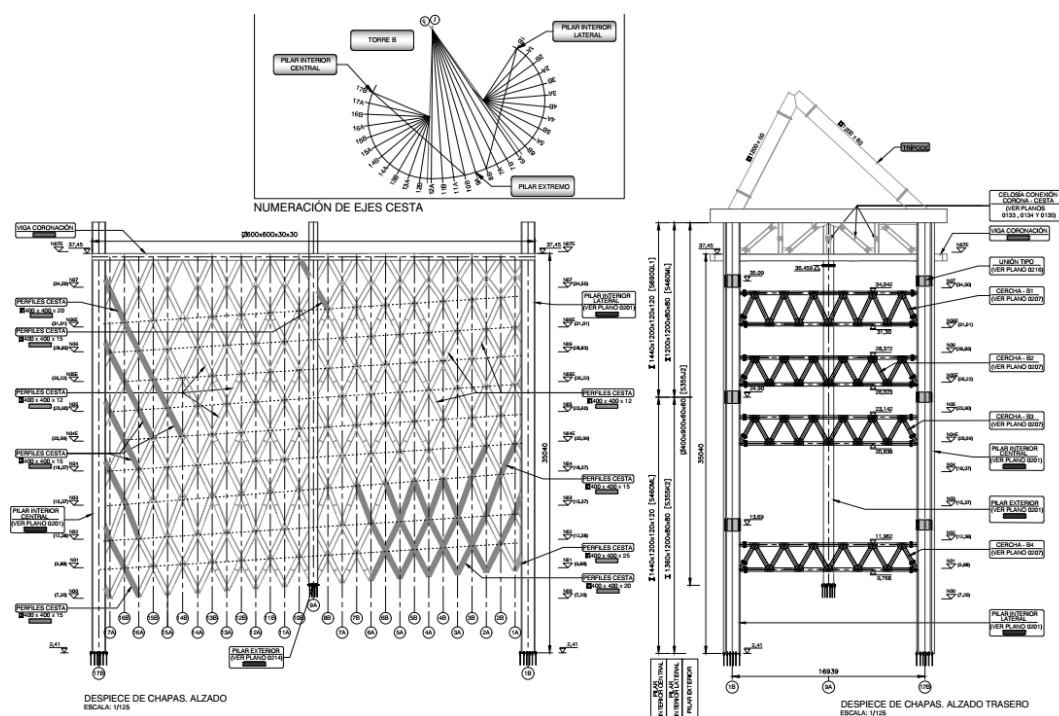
Alzado desarrollado de la cesta, y pilares principales
